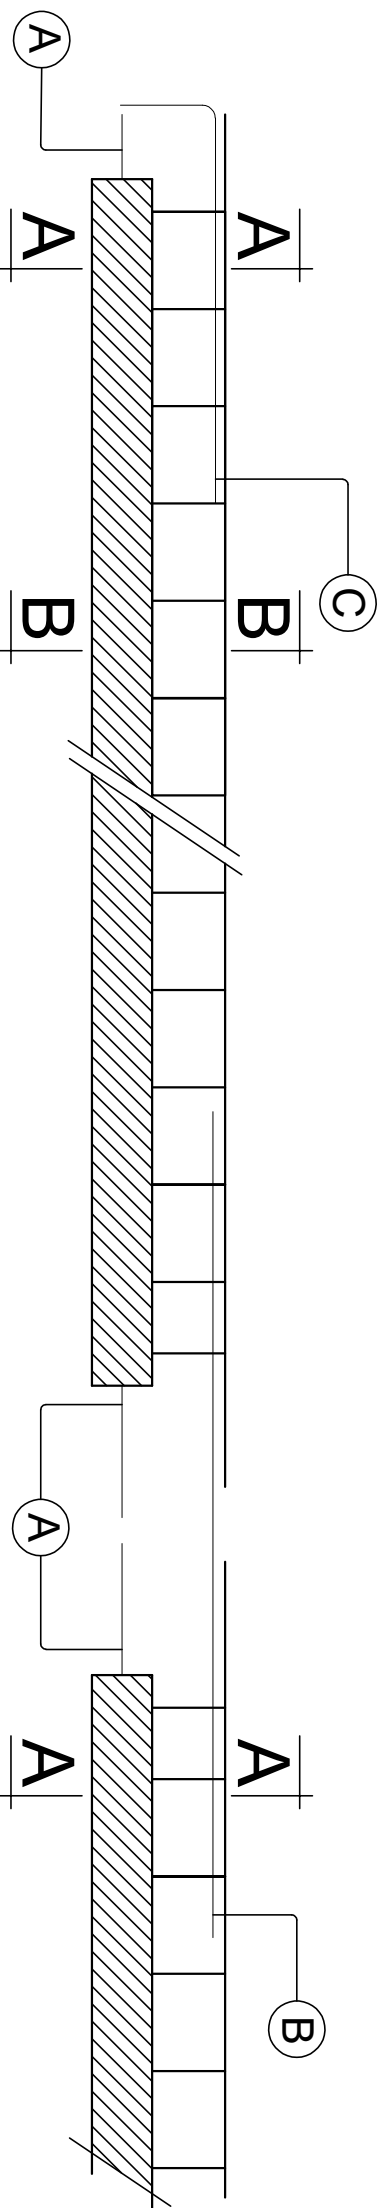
Coupe schématique du ferrailage du plancher
